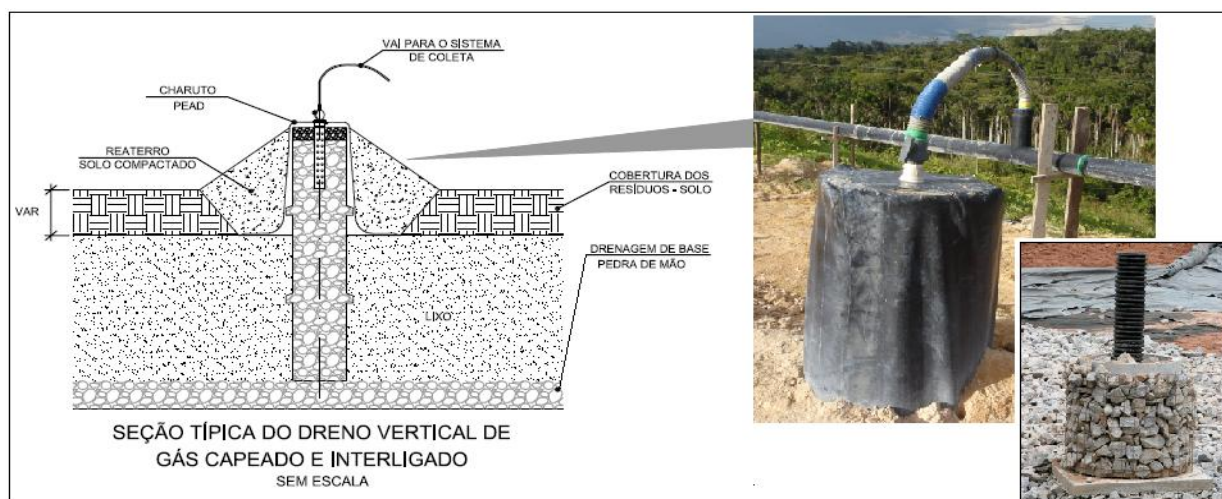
Conexão típica para recuperação dos drenos verticais.
